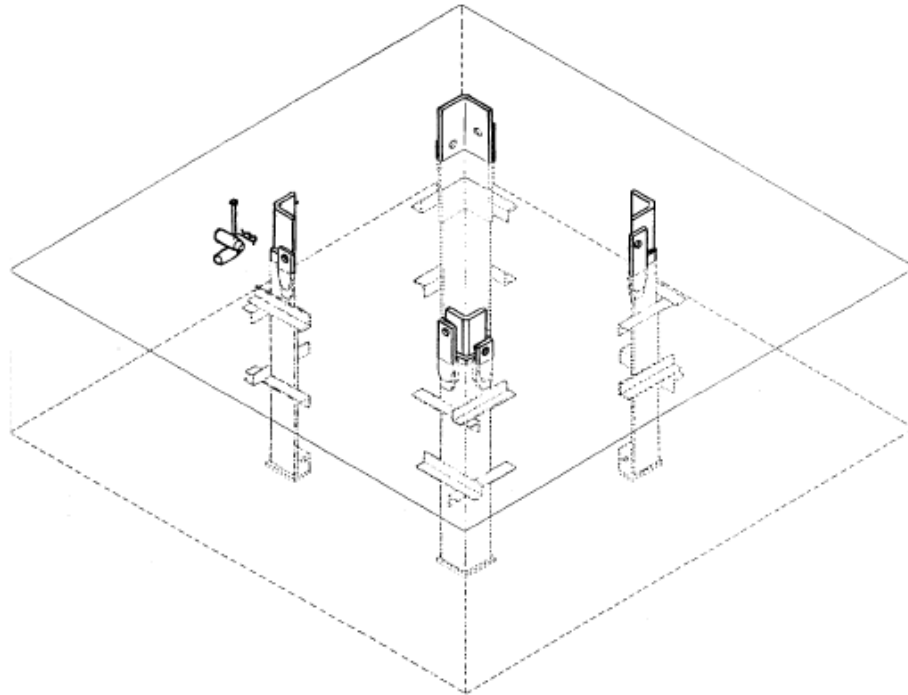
Losa de empotramiento con los pies de empotramiento embutidos en el hormigón.
